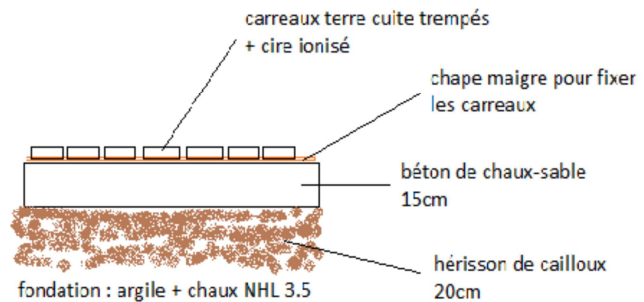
Coupe verticale de l'isolation du plancher bas
